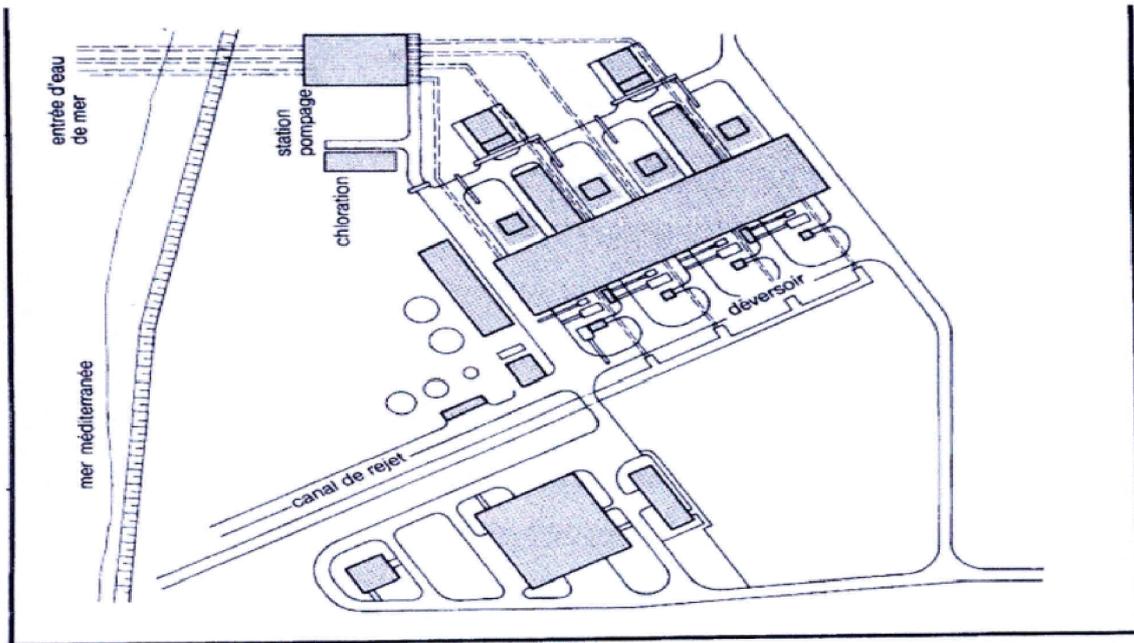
Plan de masse de la centrale thermique de CAP-DJINET.
